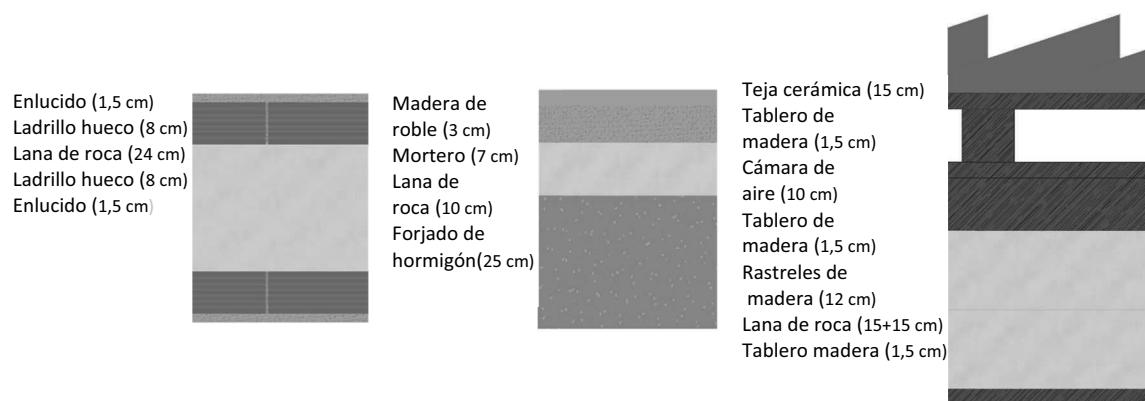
Sección muro tipo, planta sótano y cubierta, respectivamente
